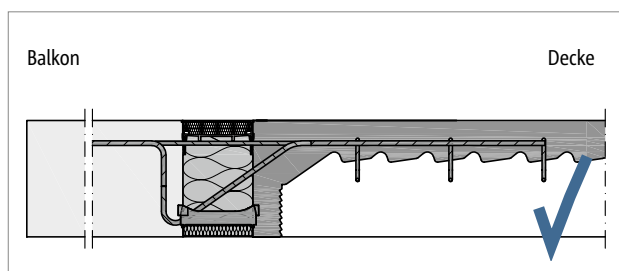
Schöck IDock®: Bündiger Balkonanschluss, hier mit Schöck Isokorb® XT Typ K-ID
